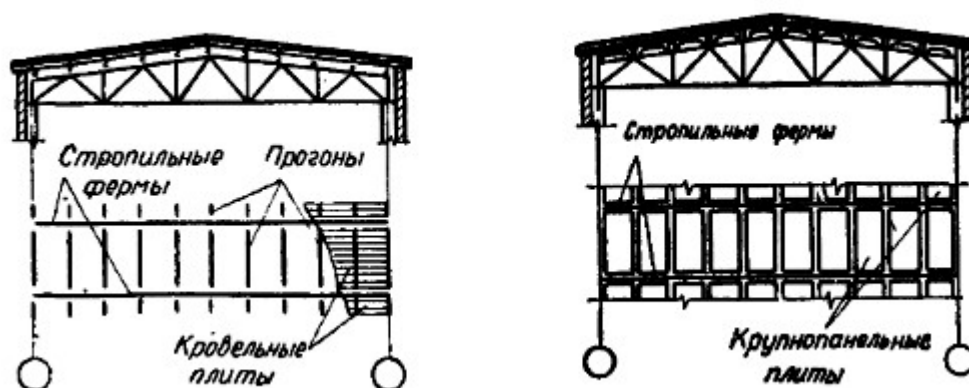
Схема прогонного и беспрогонного покрытия
